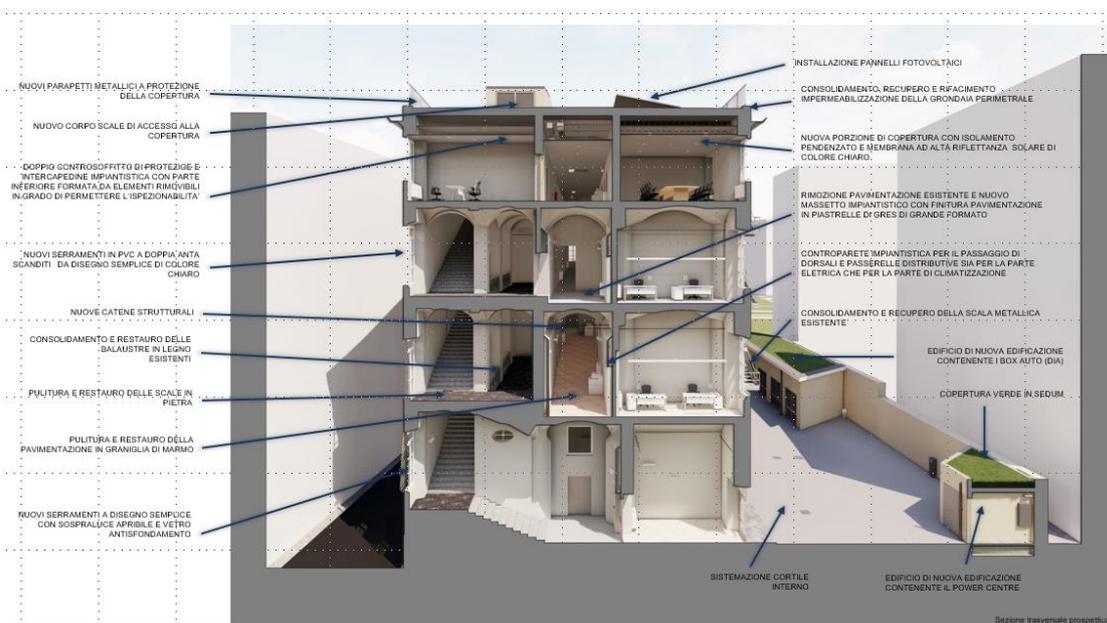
Sezione trasversale prospettica del progetto. Fonte: Studio Calvi (2021)
